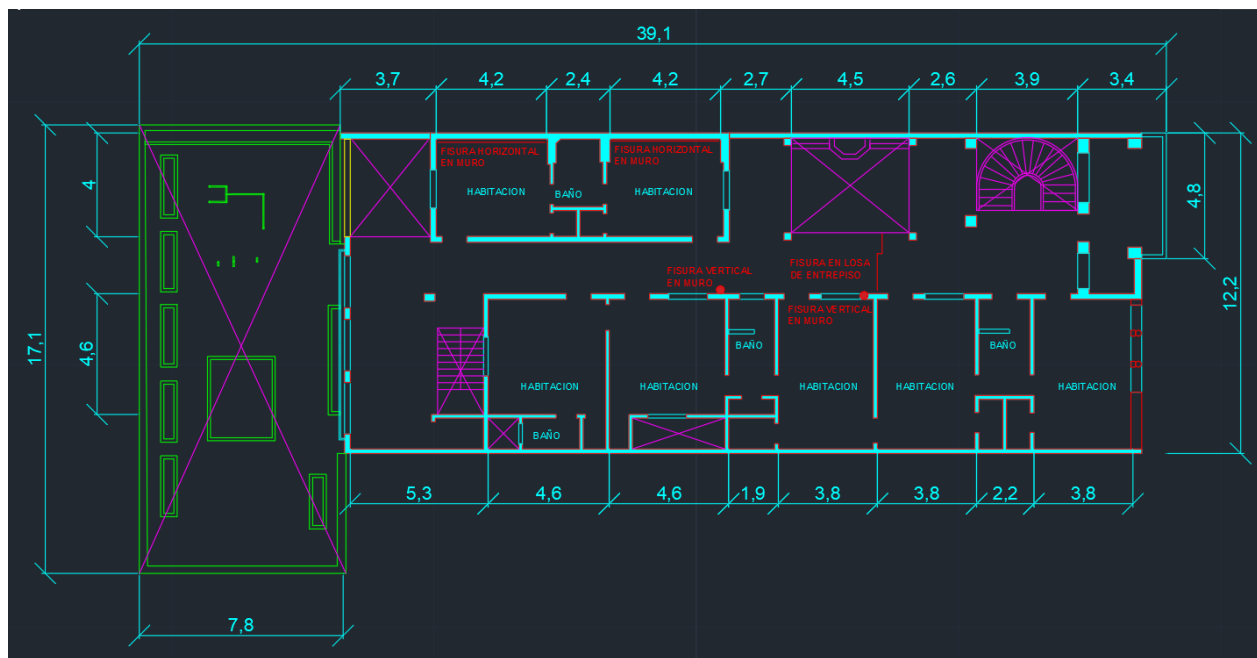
Fisuraciones en la planta del nivel 2. Elaborado por los autores, 2024.
